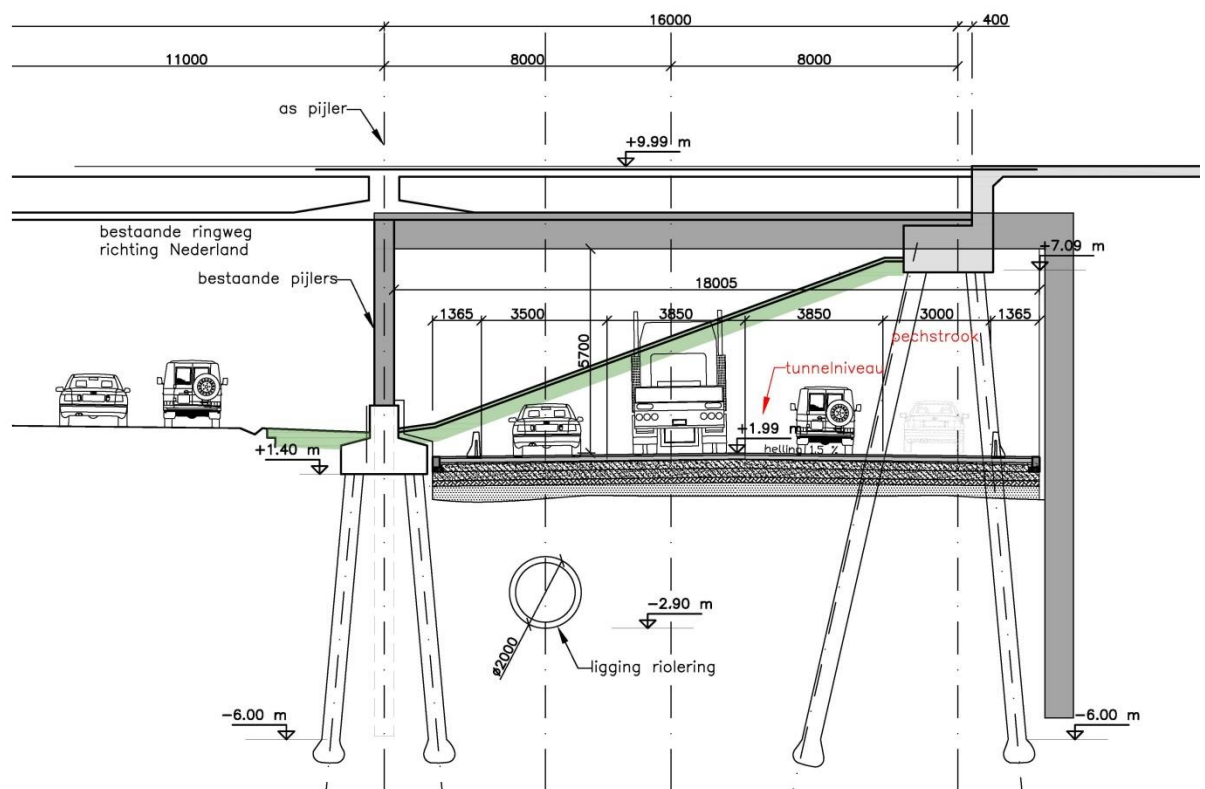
dwarsdoorsnede brug Jan van Rijswijk: projectie benodigde DRW tunneldoorsnede op bestaand landhoofd en berm
